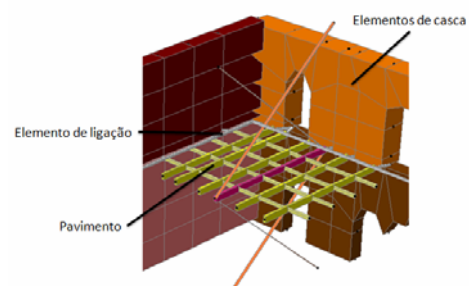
Pormenor de ligação entre pavimento e fachada.
